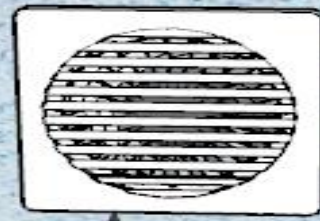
Brida drenaje 4" a 50 CM de muro al centro de brida y 50 CM a coladera de centro a centro.
